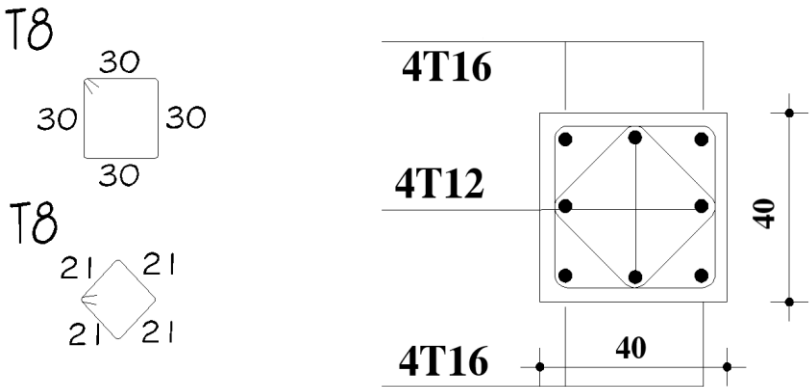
Ferrailage poteau (40×40)(\*).
